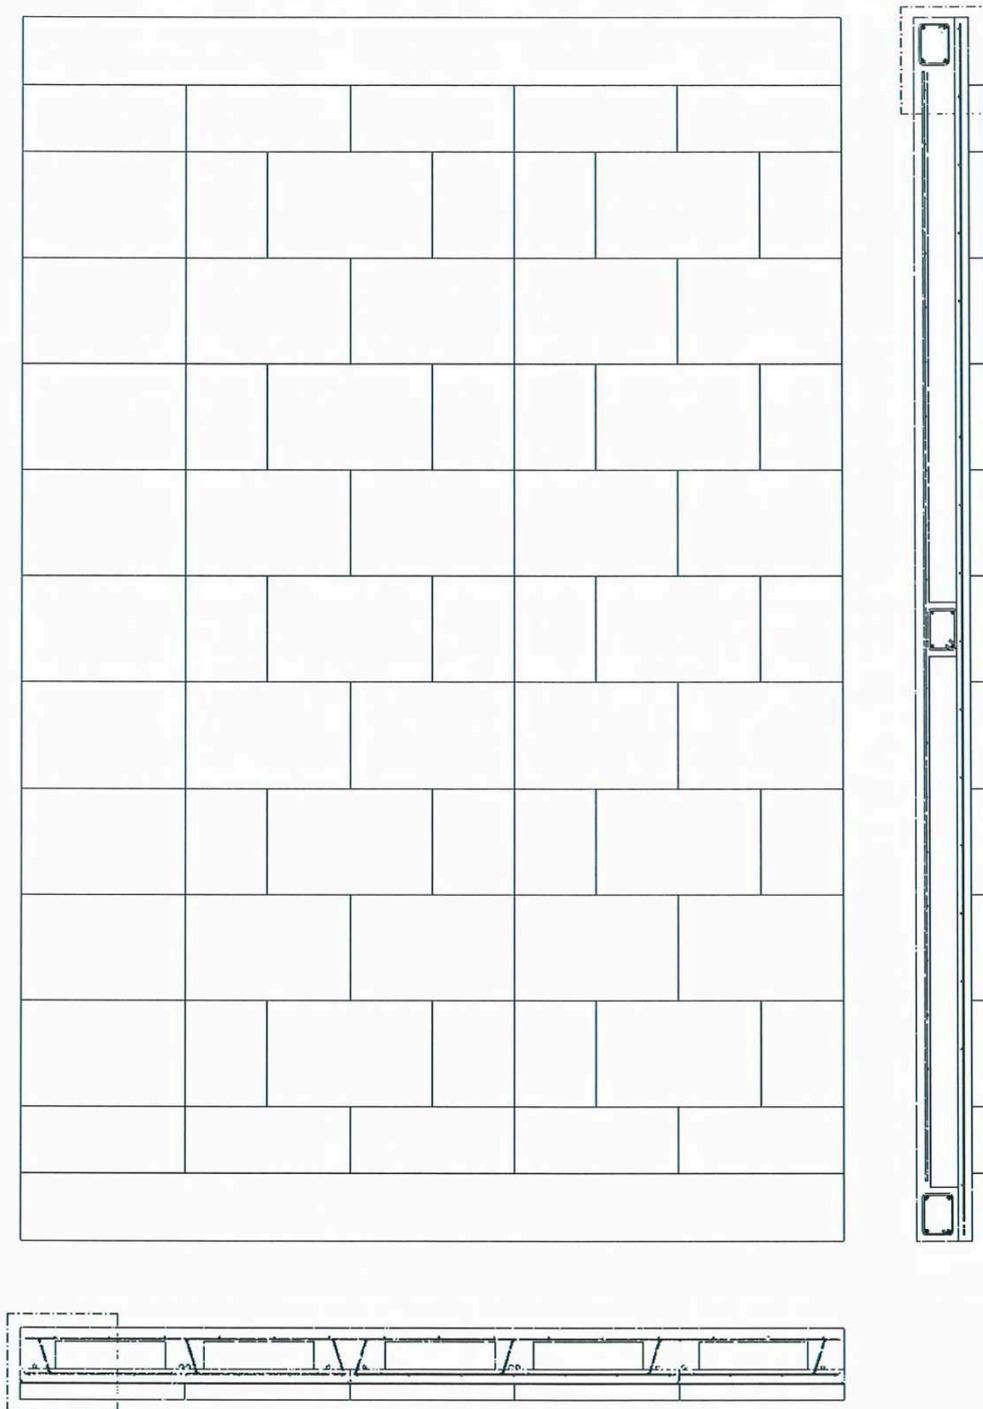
Estratto da rapporto di prova N. 323472/3714FR su solaio in predalle – vista in pianta.
